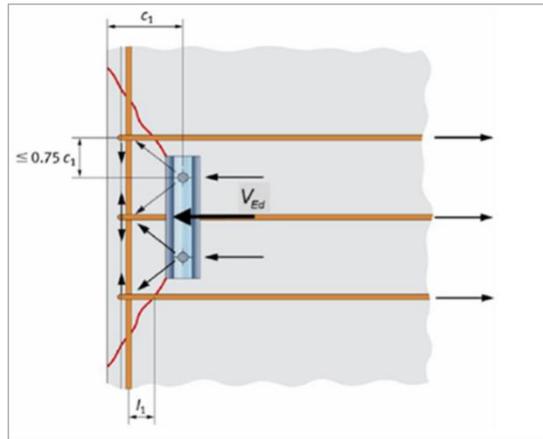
槽式预埋件受剪时附加钢筋布置示意图
